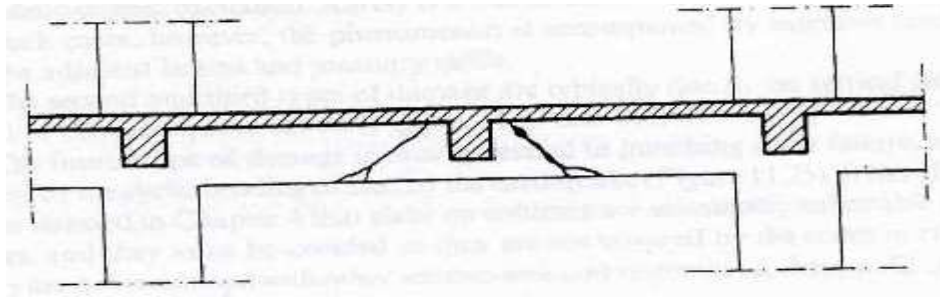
échec de cisaillement ou de flexion dans les points où les poutres principales sont les supports des poutres secondaires.
